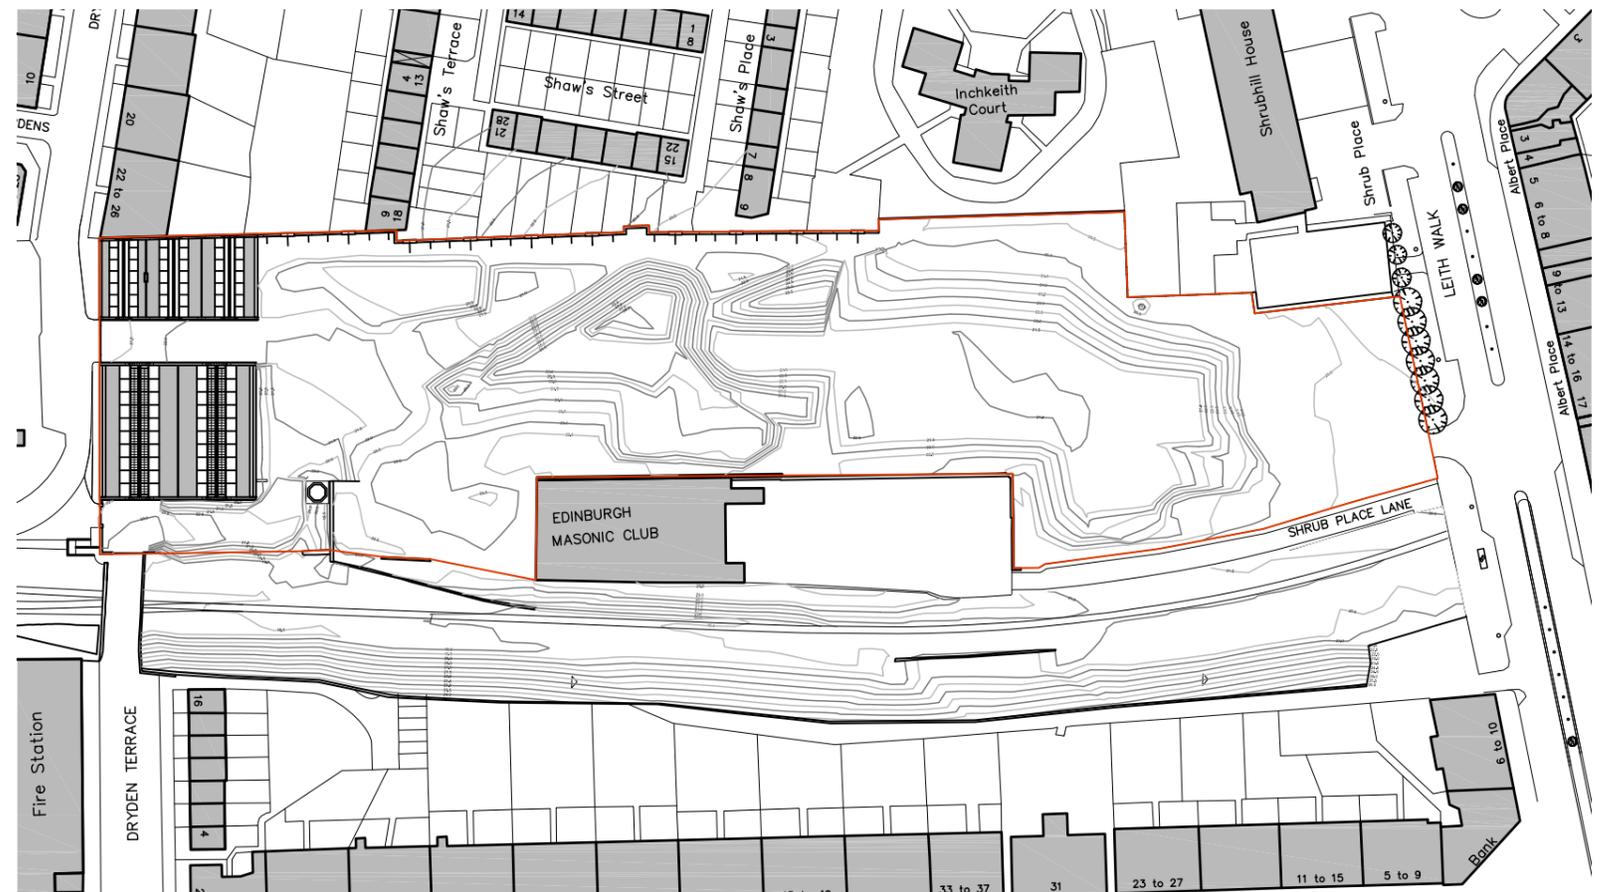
Höhengschichtplan vom Shrubhill Tramworks Areal
